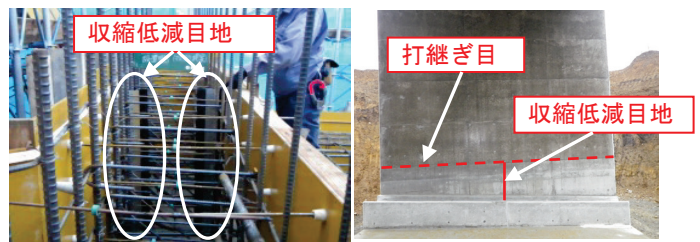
収縮低減目地設置状況 Photo. 4 仕上がり内面
